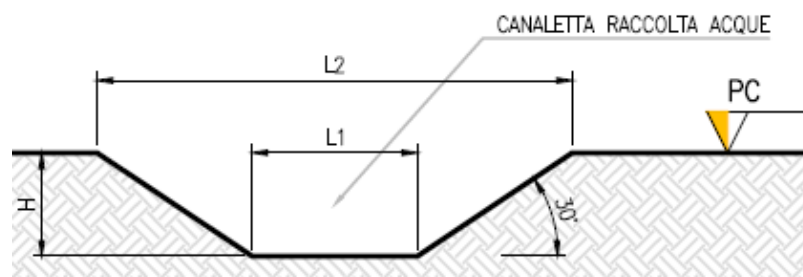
Sezione tipologica canaletta di drenaggio realizzata in scavo.
